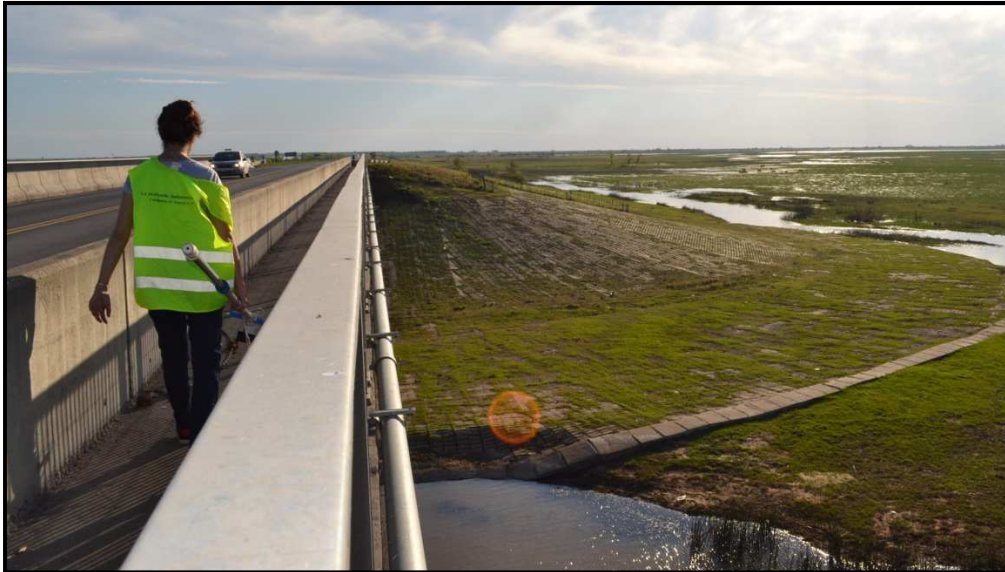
Puente en Zona de Islas-Inspección de dispositivos de apoyos
